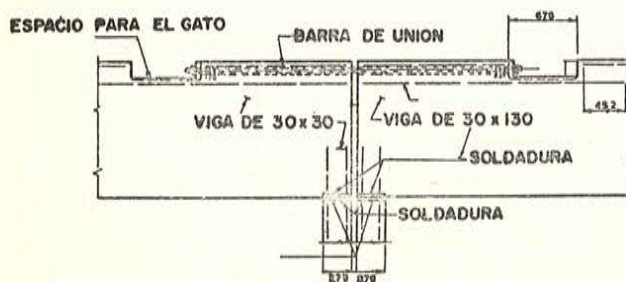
Unión entre dos vigas de la cubierta del garaje.
